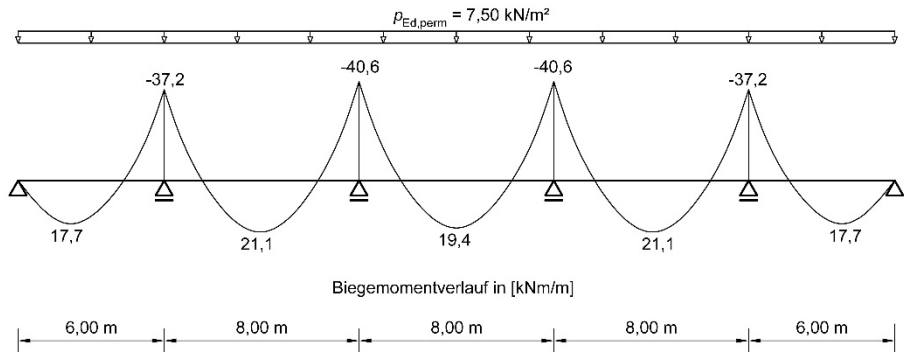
Statisches System der einachsig gespannten Stahlbetondecke und Verlauf der Biegemomente infolge der Eigenlast
